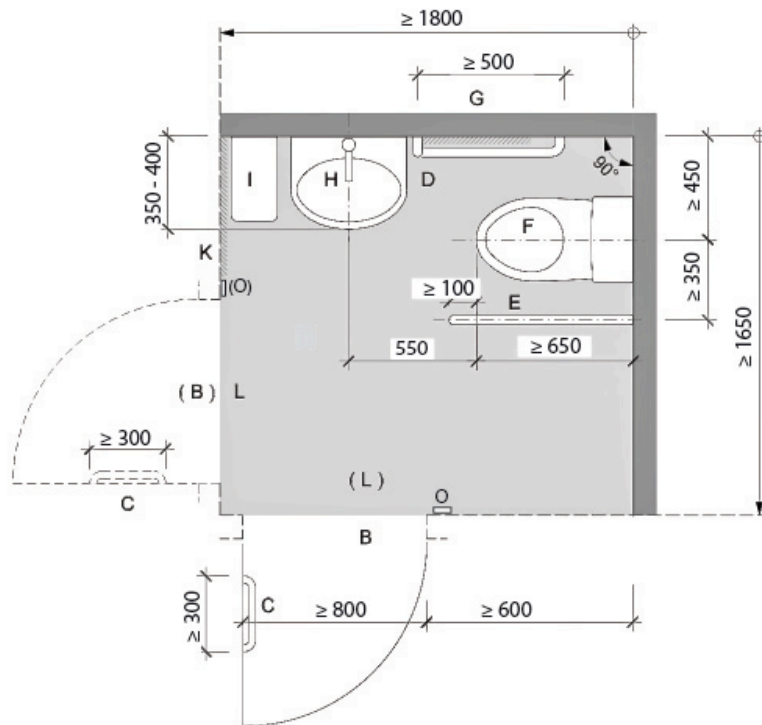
Grundriss-Vorschlag (Legende siehe Bild 1, Masse in mm) nach Norm SIA 500.
